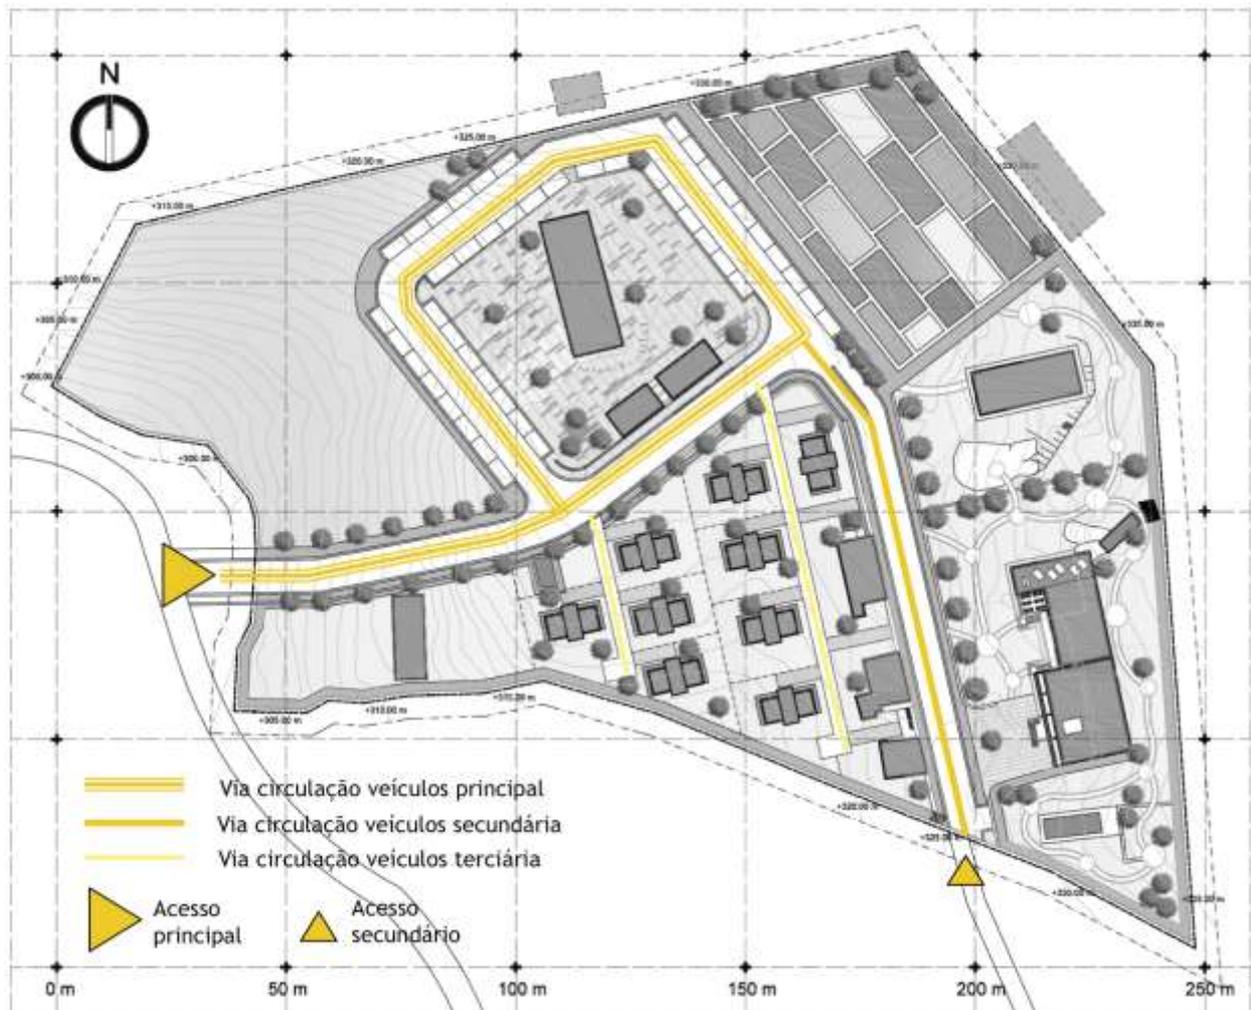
Planta localização vias de circulação automóvel e estacionamento.
